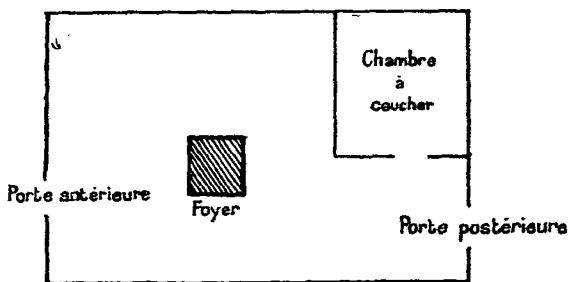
PLAN D'UNE CASE P'U-NOI.
